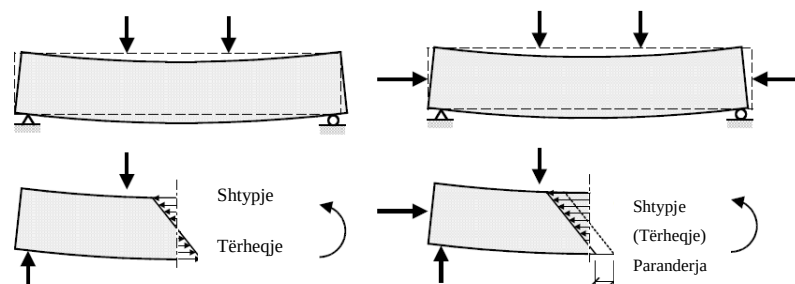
a) Trau prej betoni ne përkulje b) Trau prej betoni i paranderur [26]
